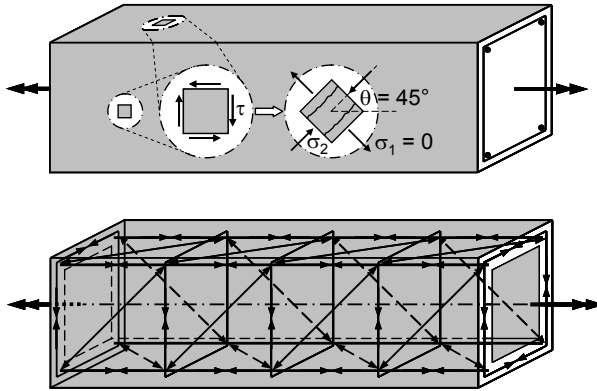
Grundlegendes 45° Fachwerkmodell von Rausch für torsionsbeanspruchte Stahlbetonbalken mit Bügeln rechteckig zur Stabachse.
